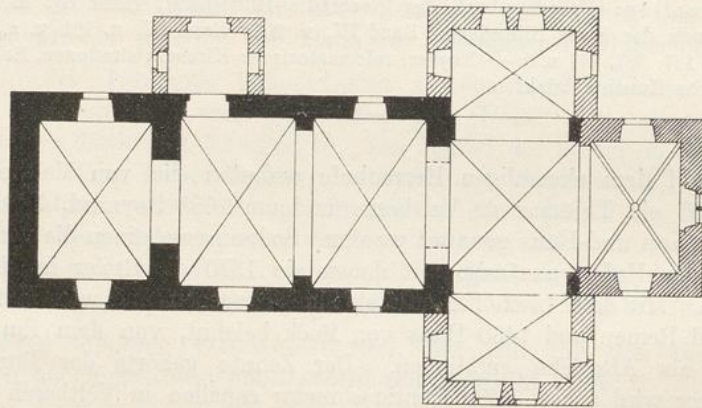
Kirche in Feldbergen; Grundriß (Maßstab 1:250).
